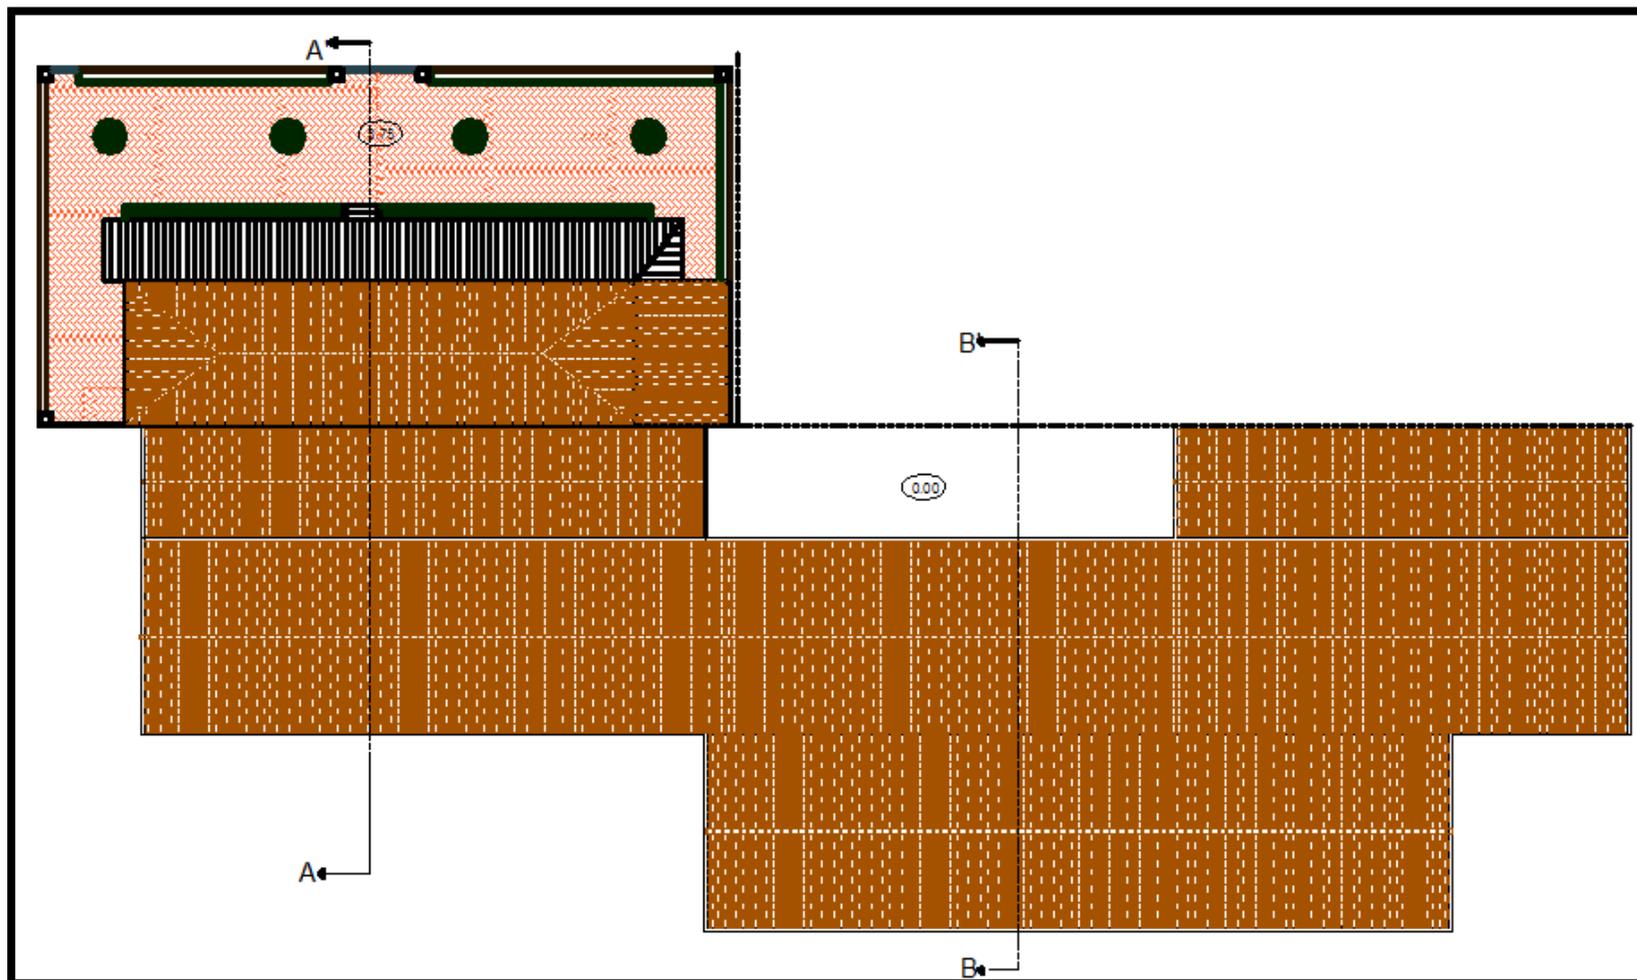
plan de toiture Des Ateliers Des Mines et la clinique des mineurs
